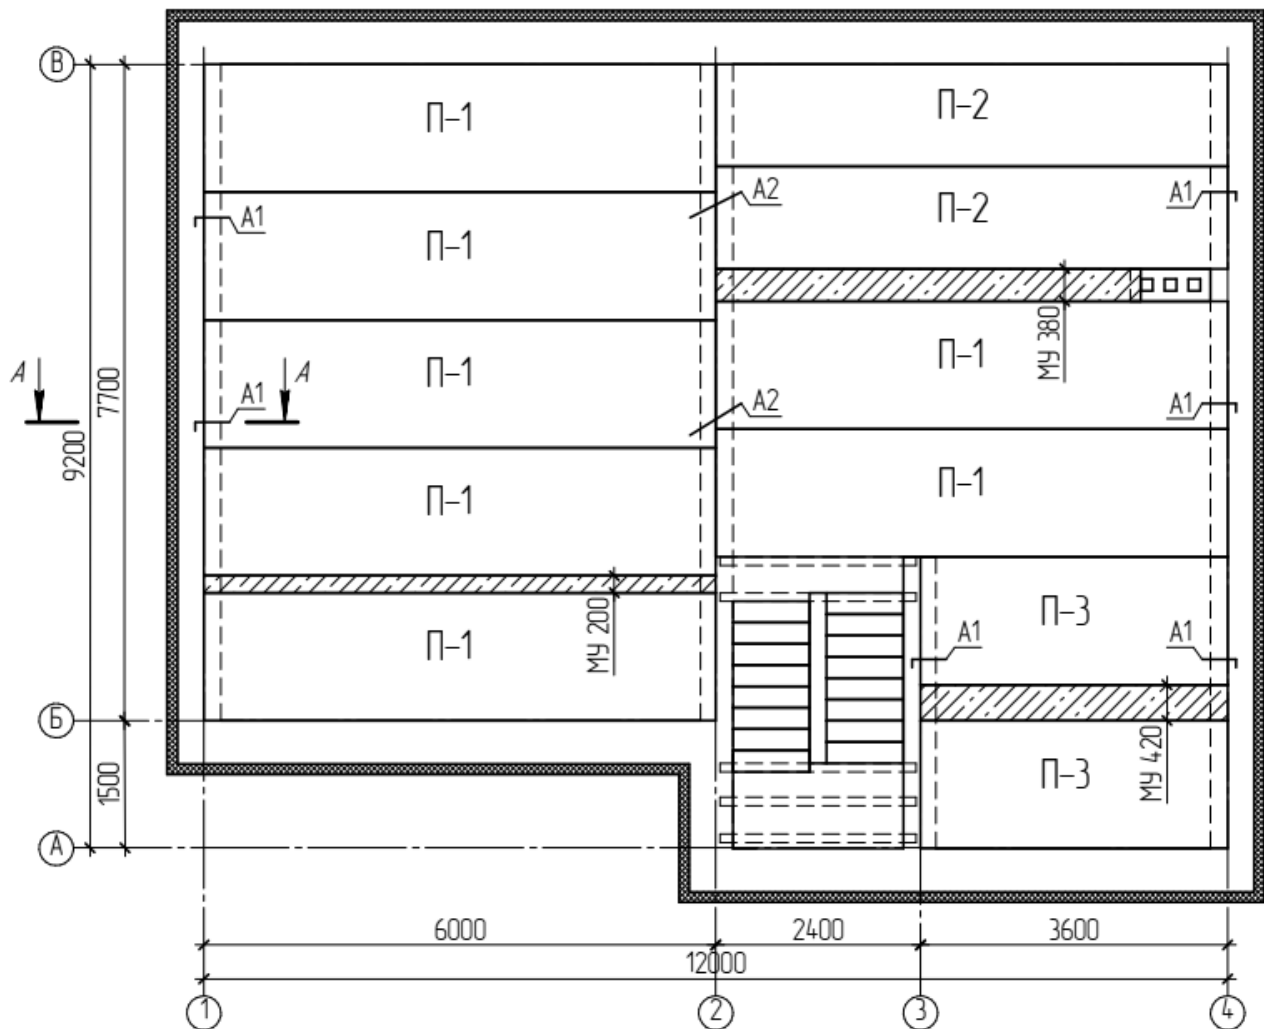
Пример выполнения схемы расположения элементов перекрытия
